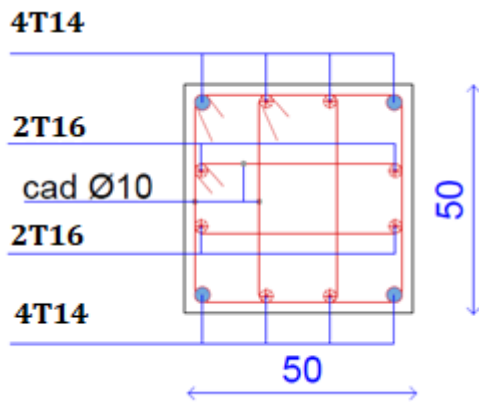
Schéma de ferrailage des poteaux (50*50) cm² de 1^{ère} et 2^{ème} étage .
